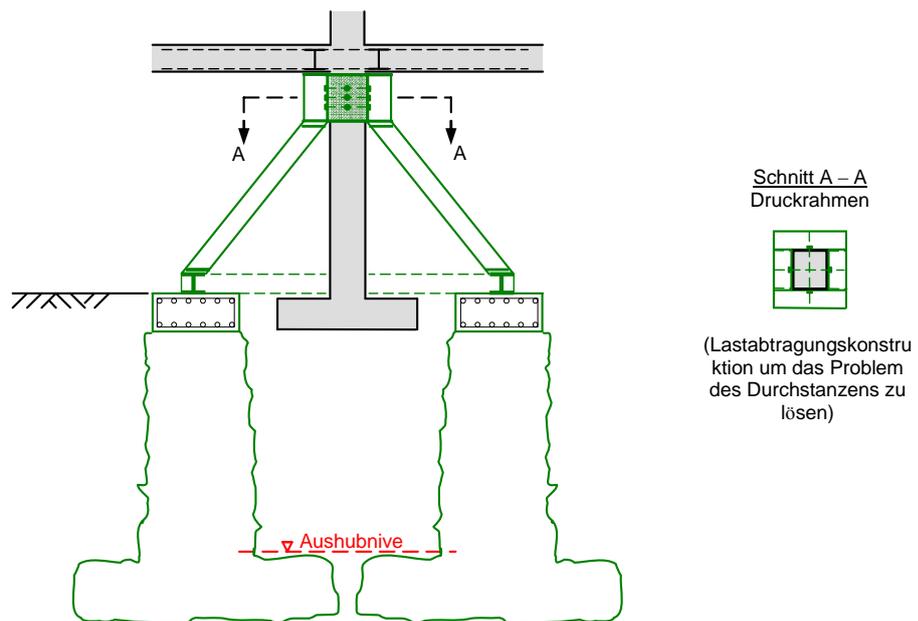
Konstruktives und Baubetriebliches System (Variante III):
